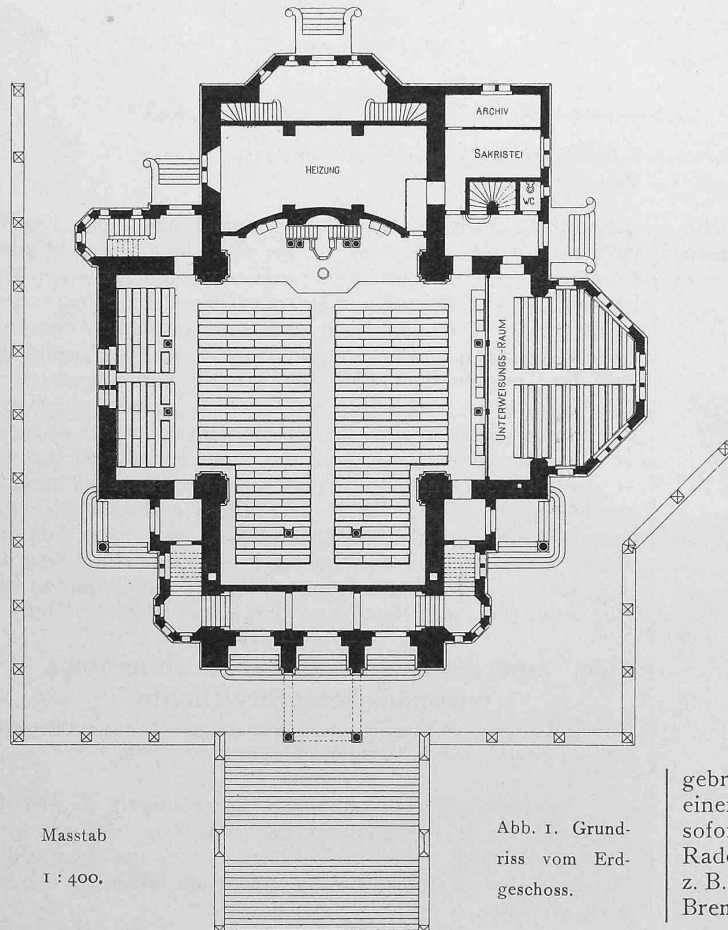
Grundriss vom Erdgeschoss.
